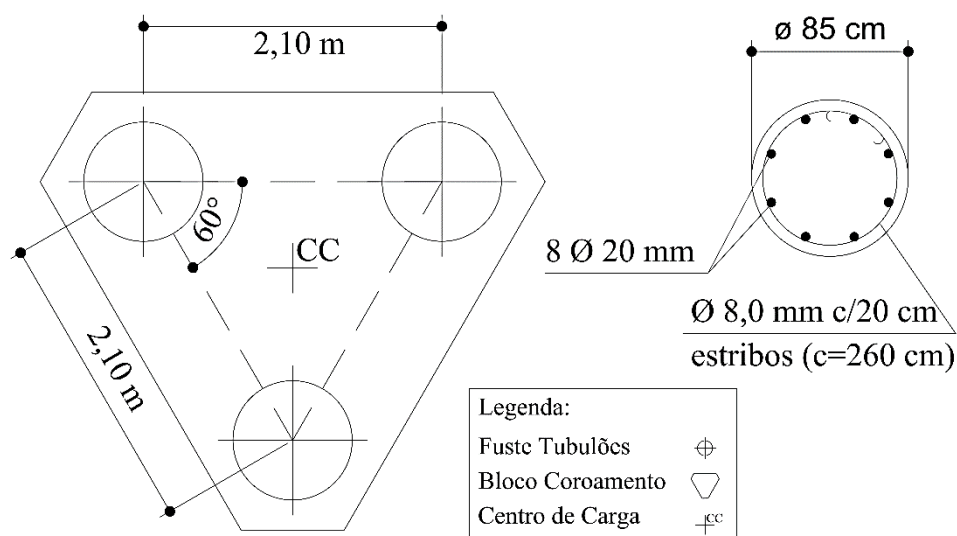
Projeto dos tubulões e armadura utilizada.
